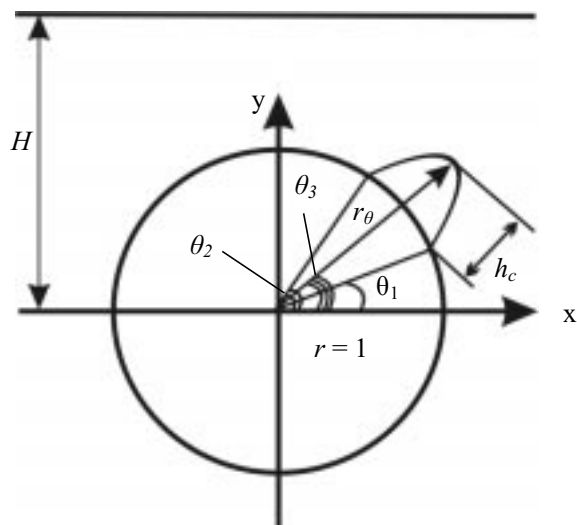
Расчетная схема к определению нагрузки на крепь от локального вывала в слоистом массиве.
